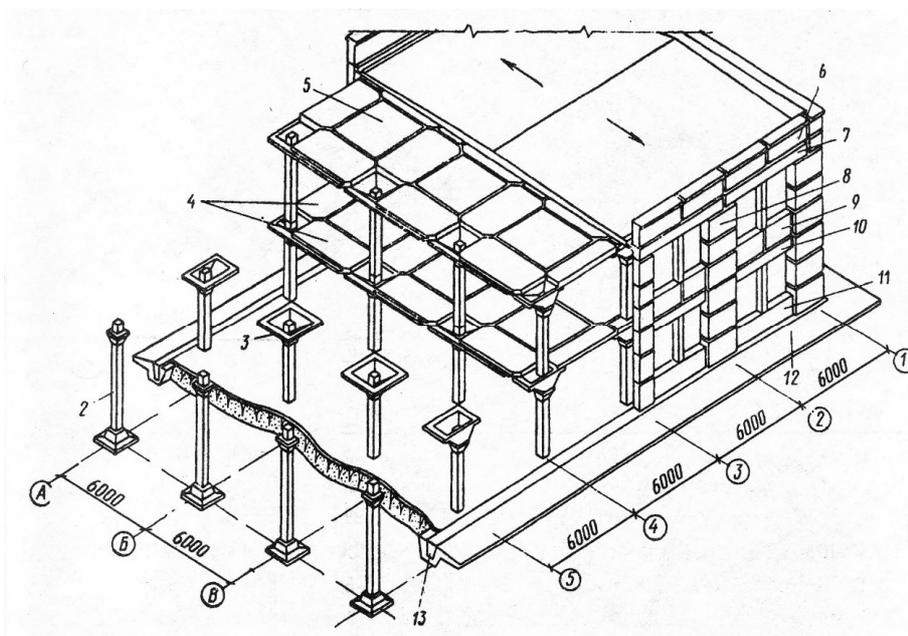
Многоэтажное здание с безбалочным каркасом:
